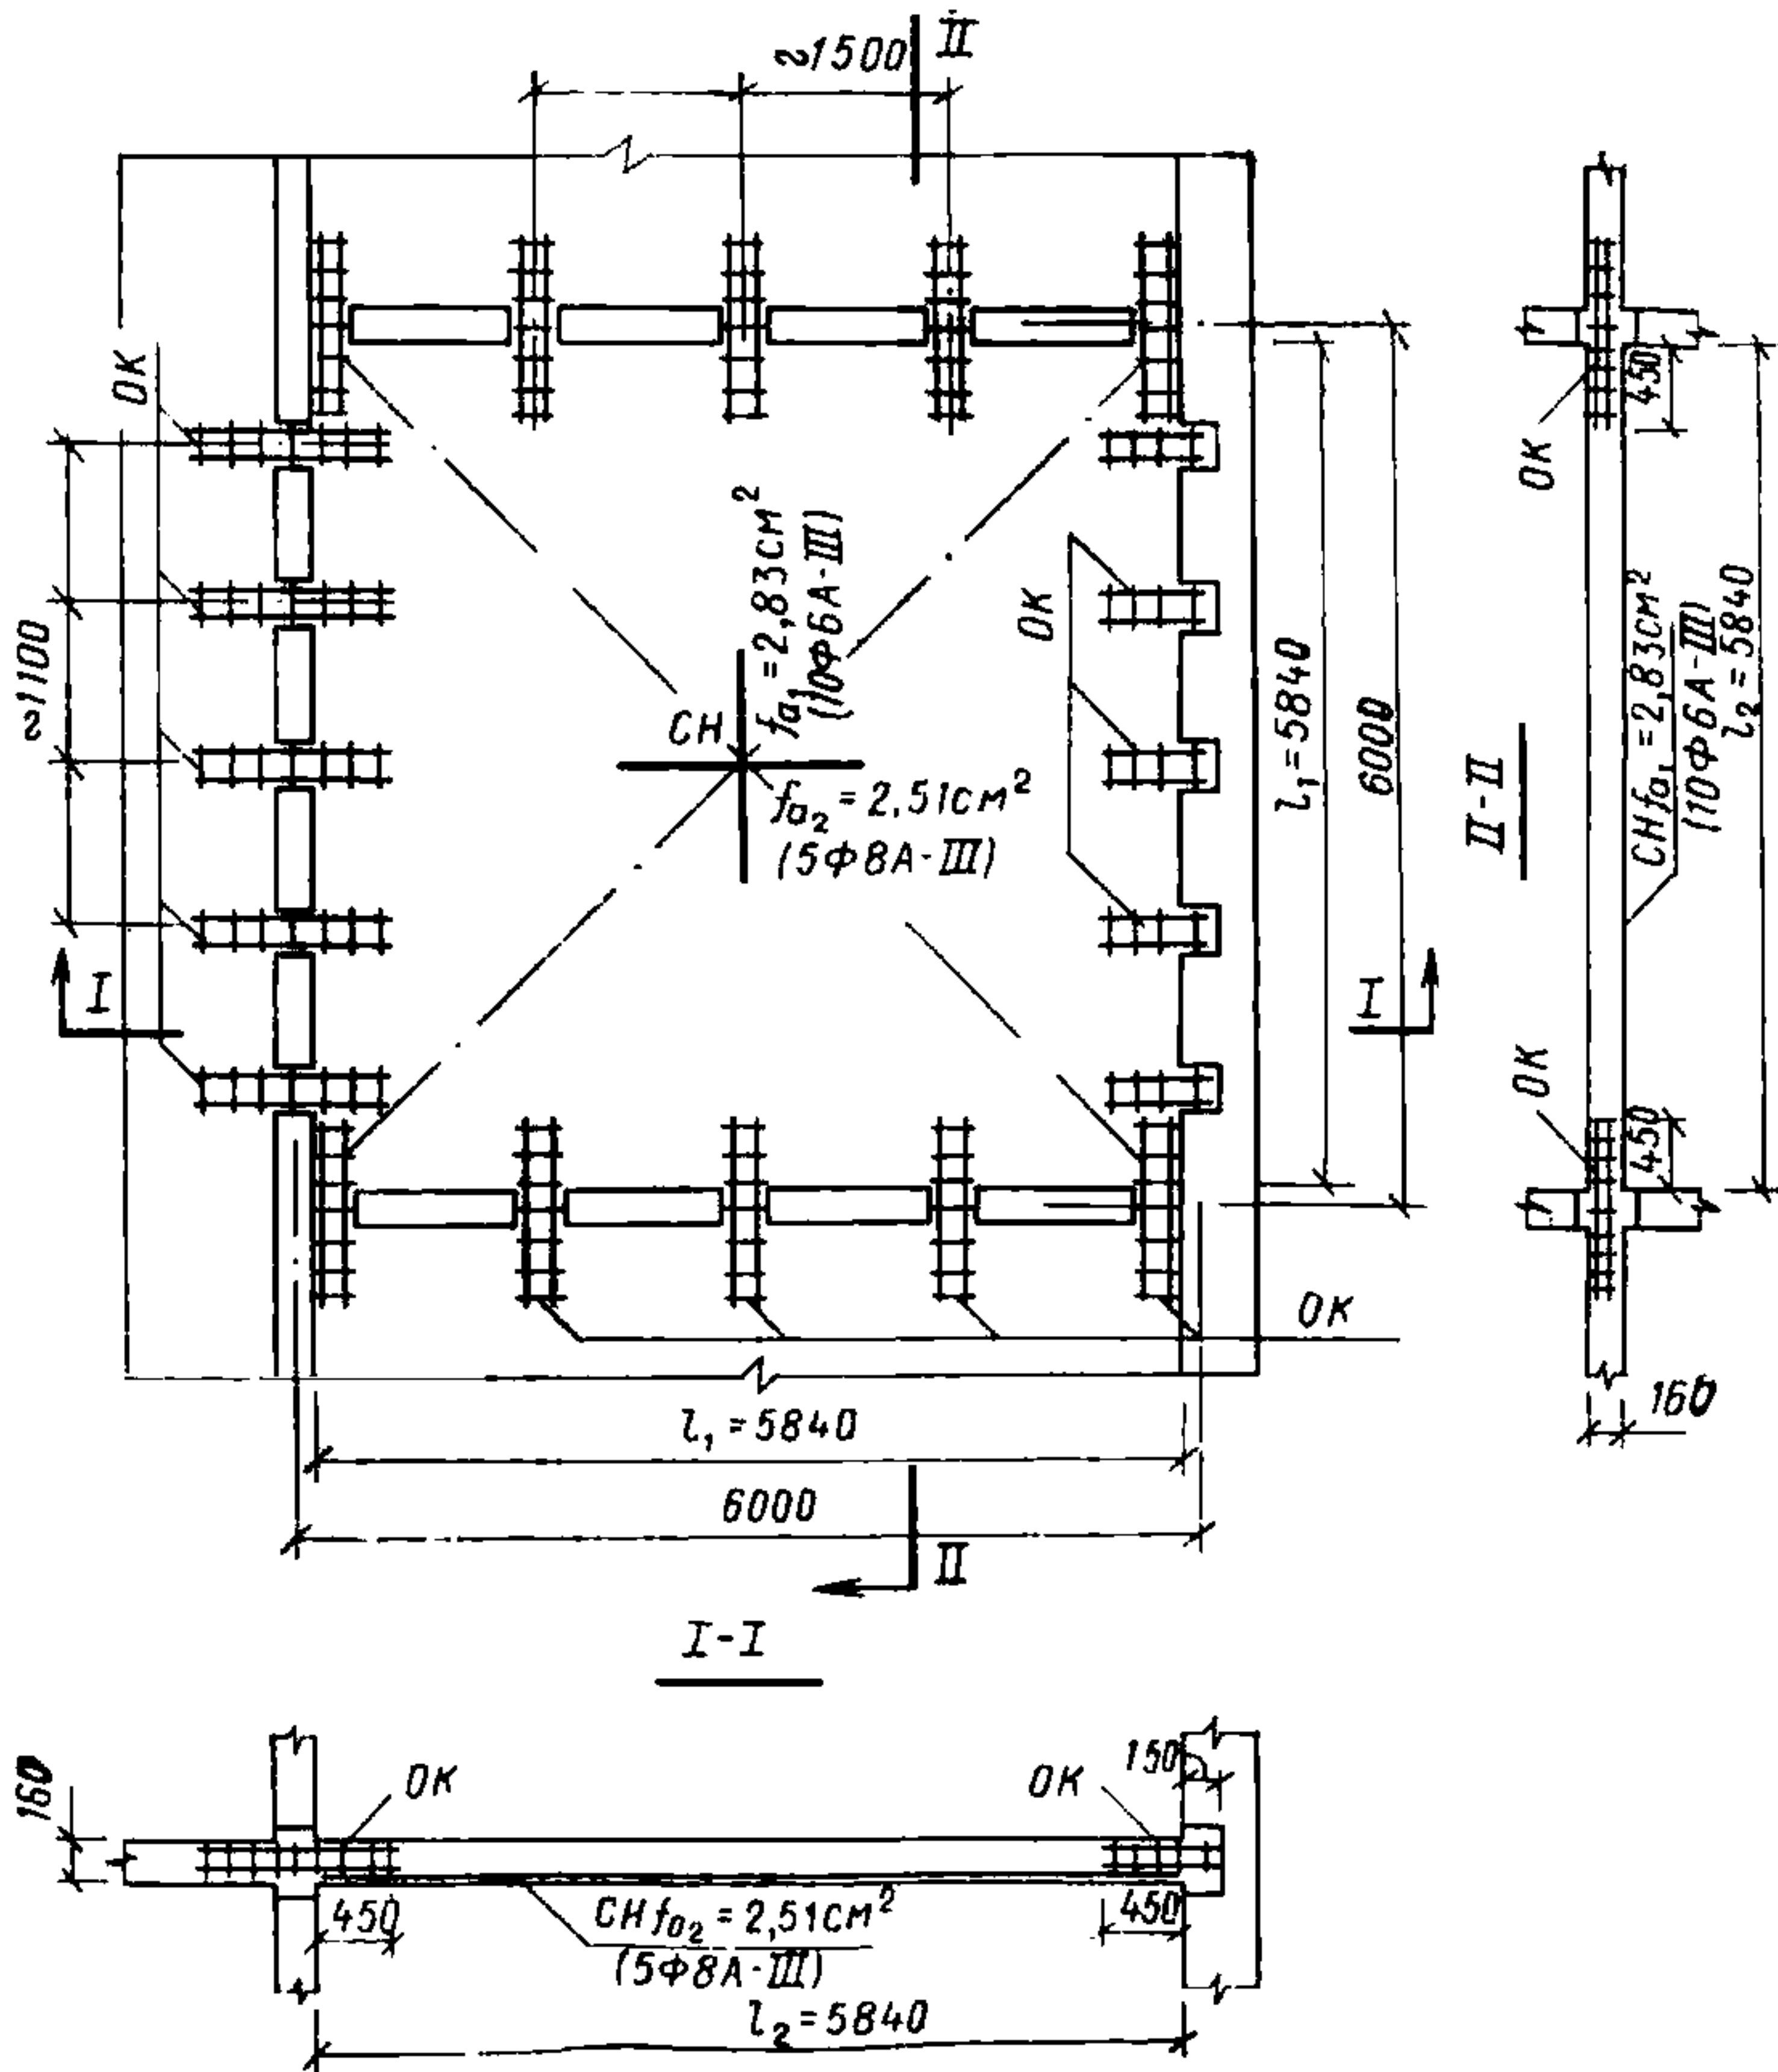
Схема армирования плиты перекрытия с прерывистым опиранием по расчетной схеме «плита, свободно опертая по контуру»
